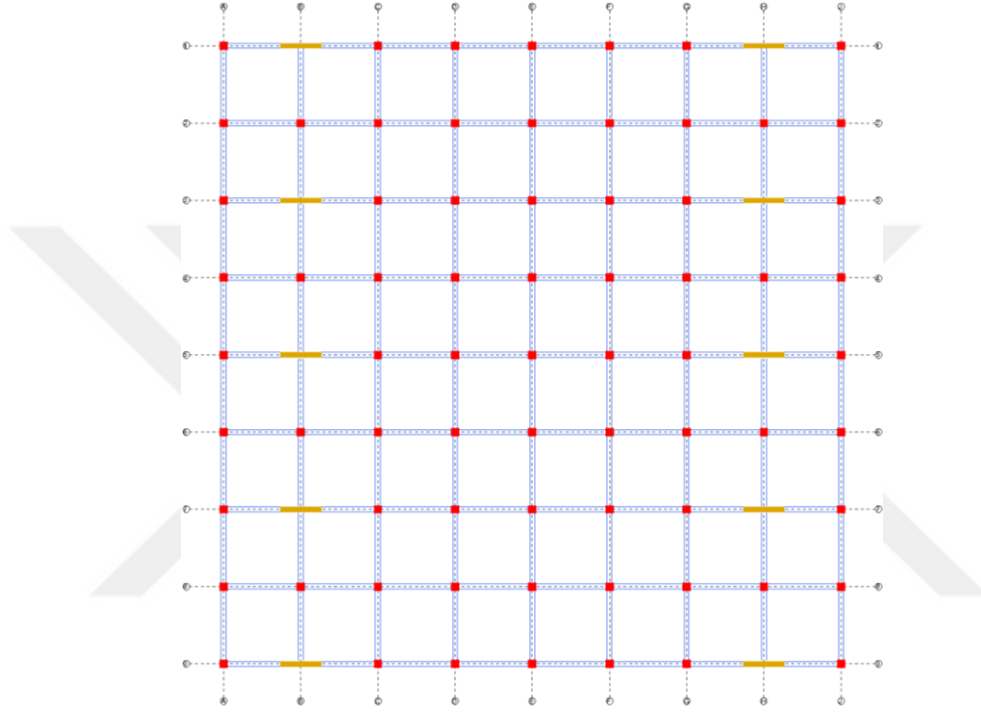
Model 10.1 'e Ait Kat Planı
